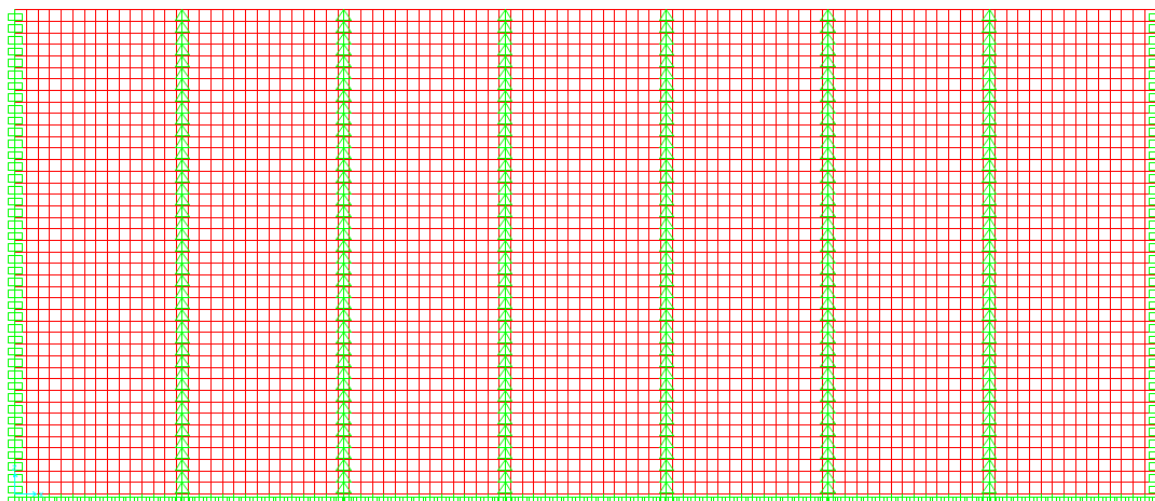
Schema strutturale di vincolo della parete esterna.
